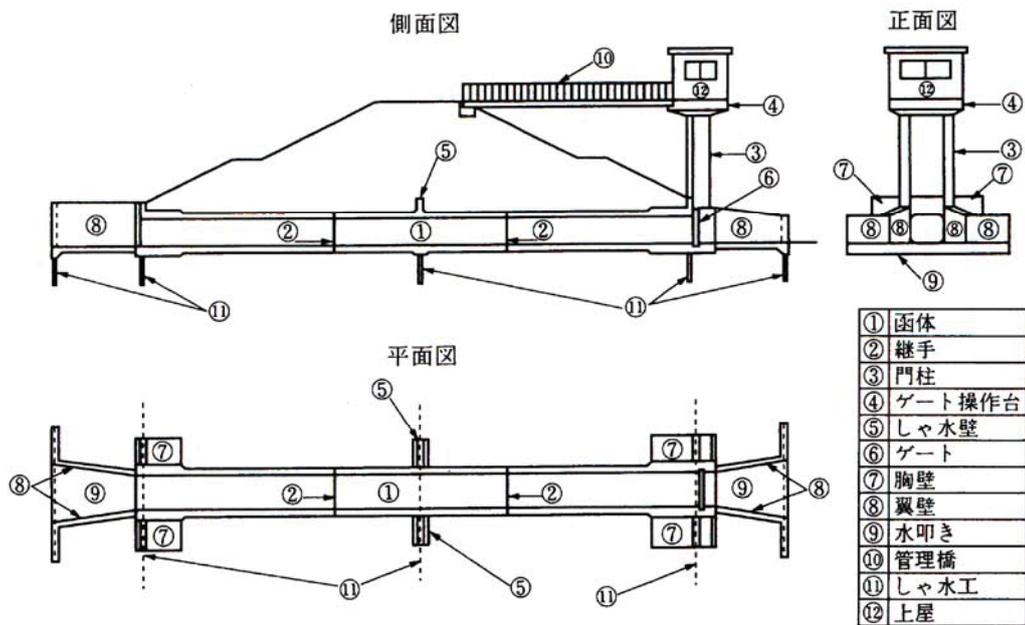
樋門構造の基本構成および各部の名称（コンクリート構造）
